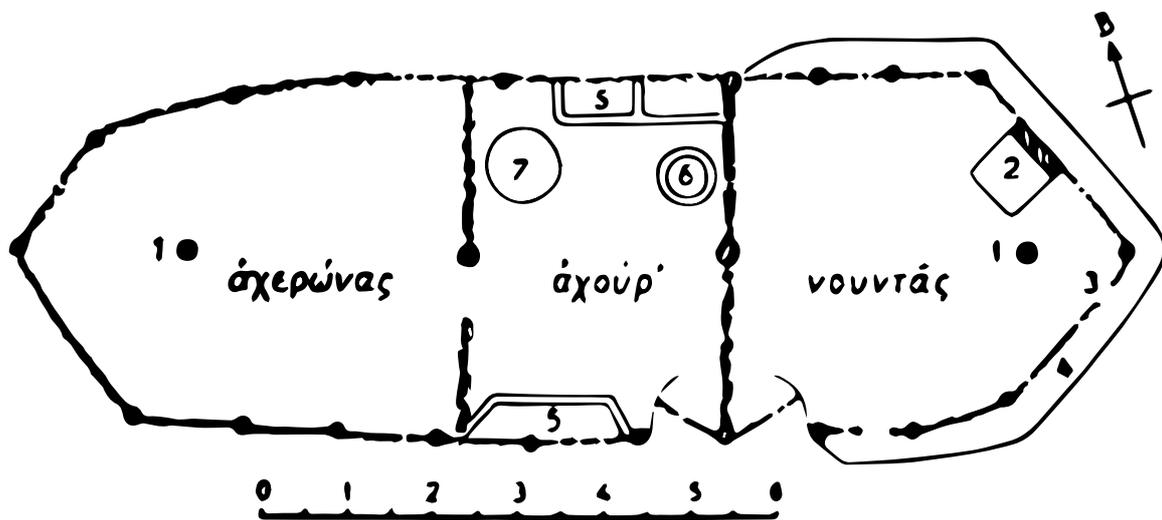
e: Grundriss einer „Strohdach“-Bauernhütte, die 1927 in der Nähe von Karditsa gebaut wurde.
